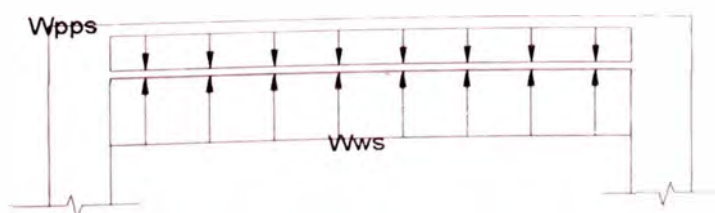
Cargas sobre losa superior del Sifón Lleno
